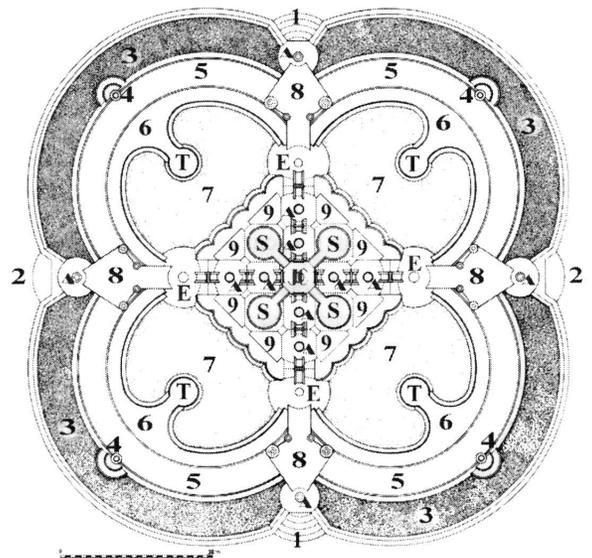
Planta de la cubierta, interpretación de T. Torii
